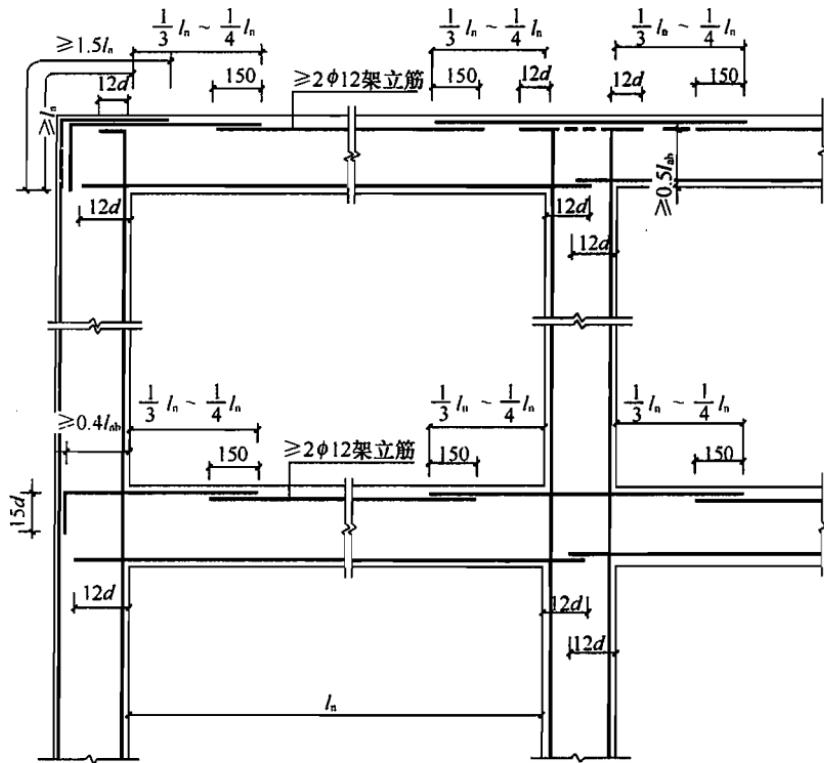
非抗震设计时框架梁、柱纵向钢筋在节点区的锚固示意
